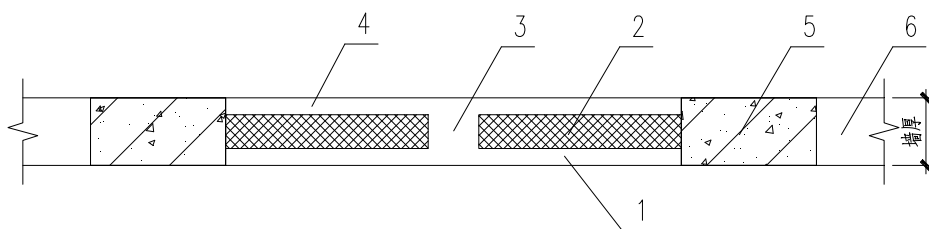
内置保温板现浇混凝土外围护墙墙身构造一
